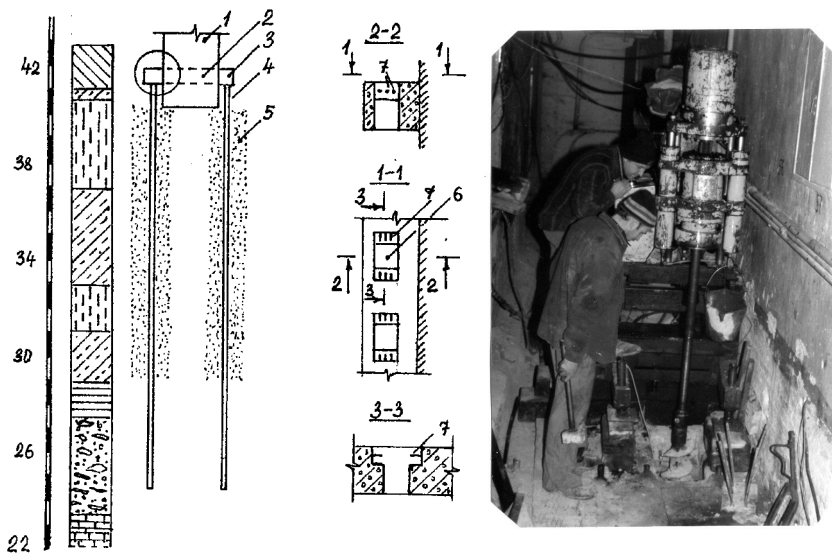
Схема сопряжения стены со свайным фундаментом: 1. Фундамент стены. 2. Поперечная балка. 3. Ростверк. 4. Буринъекционная свая. 5. Грунт, закрепленный силикатизацией. 6. Проем в ростверке для устройства свай. 7. Выпуски арматуры для сопряжения свай с ростверком
